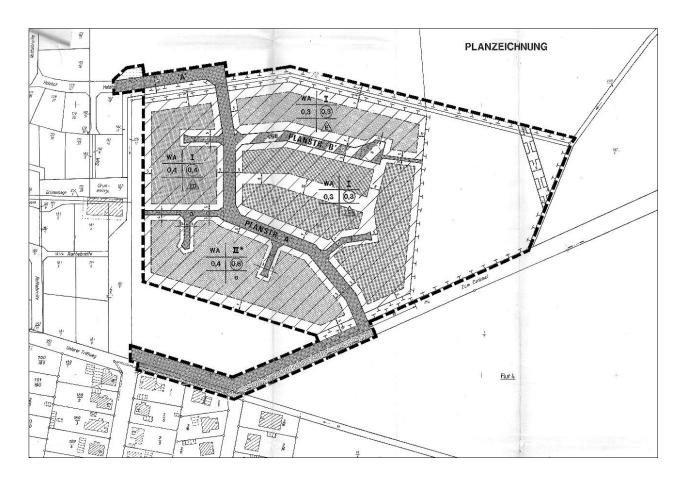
1. Bebauungsplan Nr. 38 "Rothebreite II" in Lauenau (unmaßstäbliche Darstellung)
